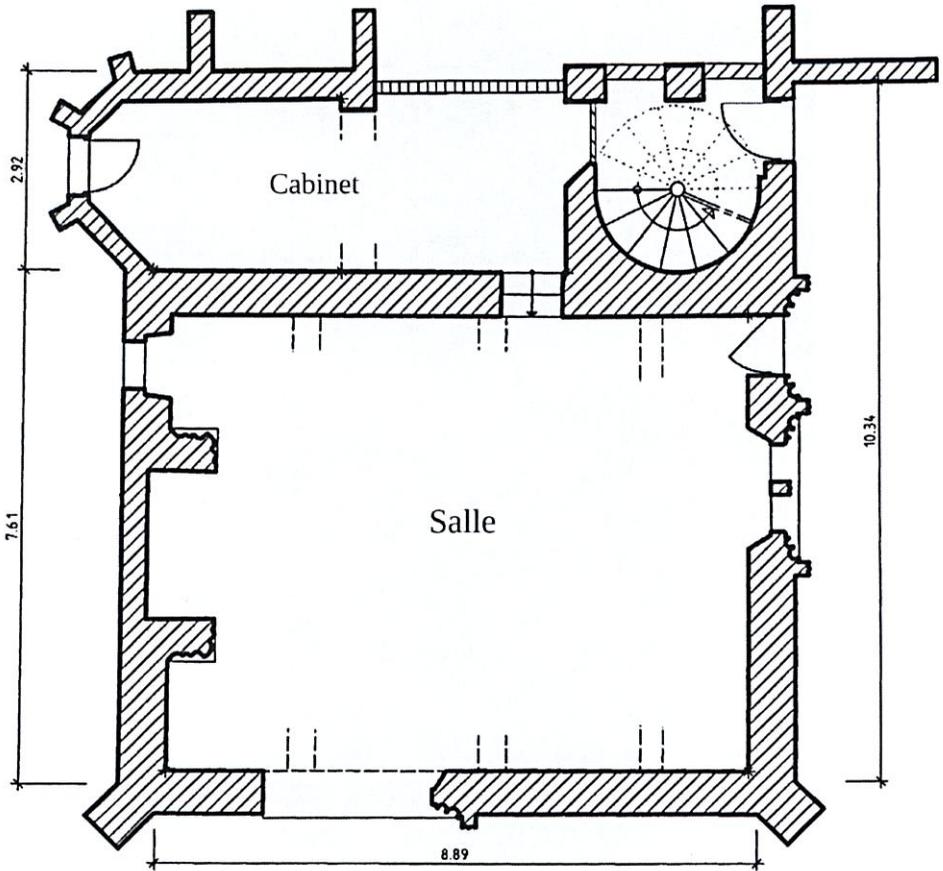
Plan du rez-de-chaussée. Xavier d'Alençon.
